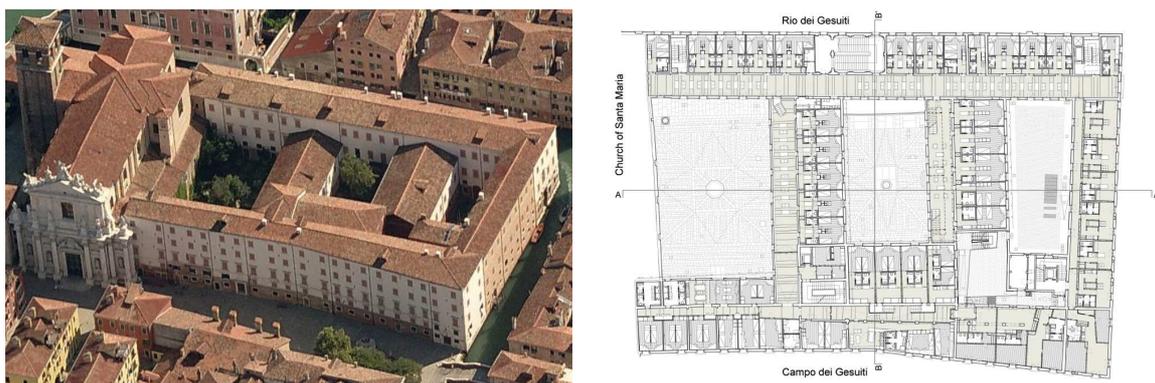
Foto aerea e pianta della parte meridionale del Convento dei Crociferi
